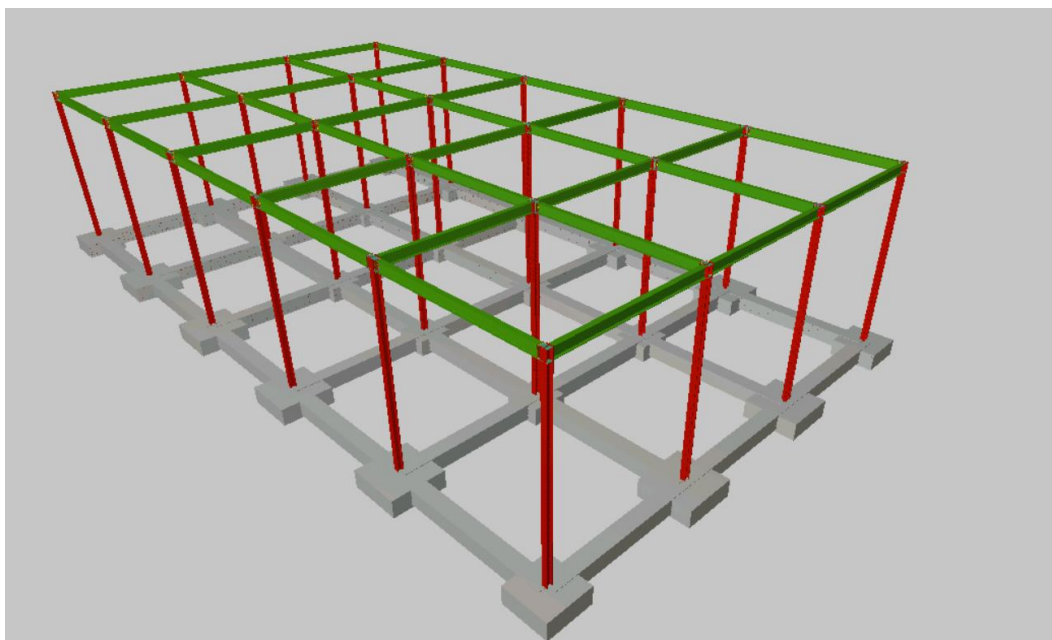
Estructura y cimentación del edificio principal. Fuente: Elaboración propia
